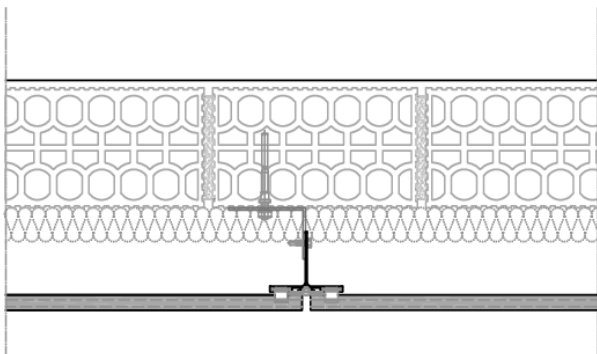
Sección horizontal. Faveton® SAH Acqua 20-H.
